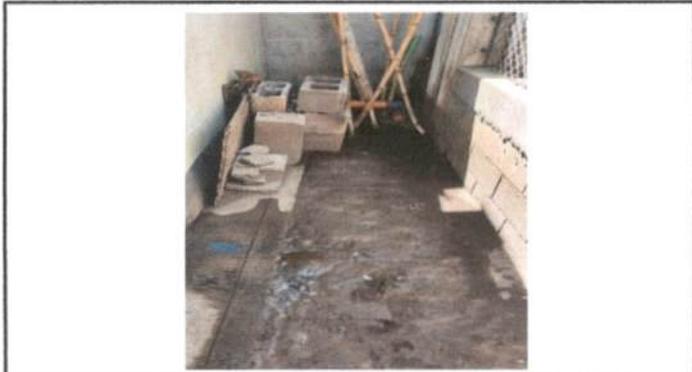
Cambio de tubería de drenaje yreconstrucción del módulo de servicios sanitarios. M 1
